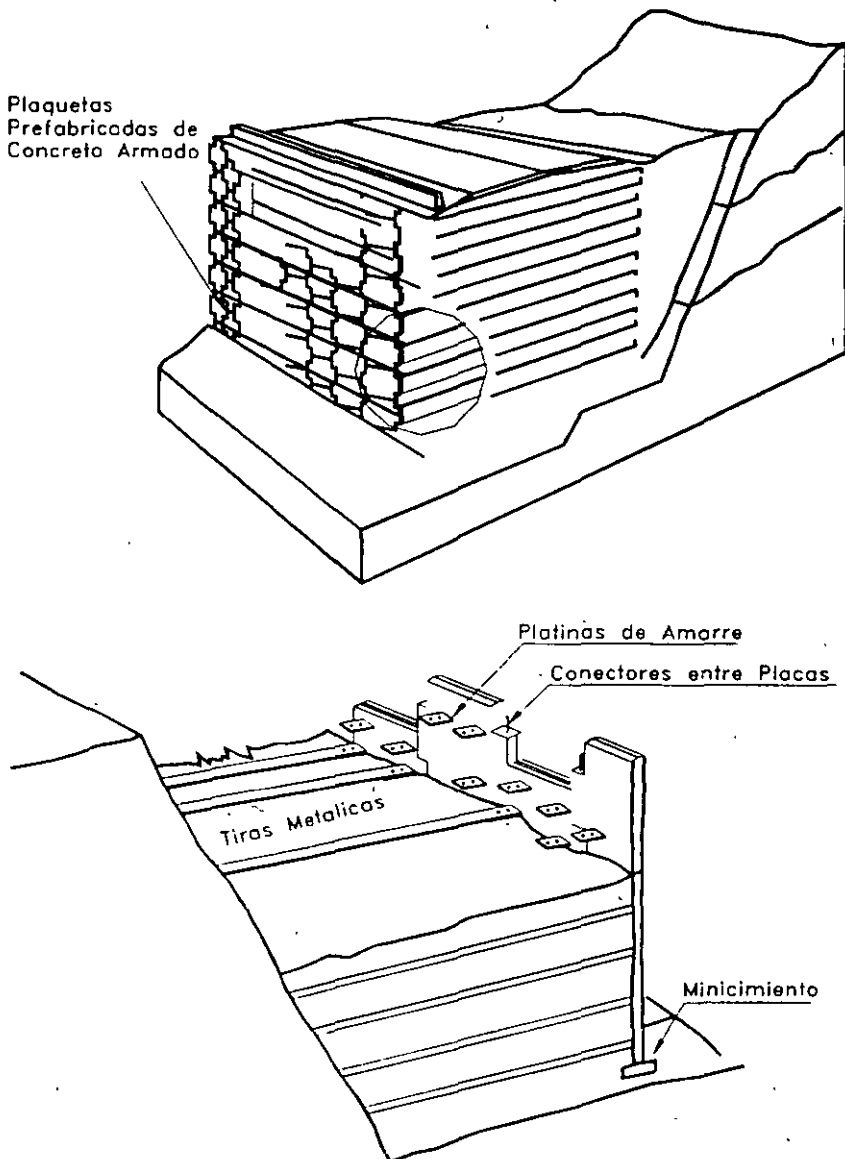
Muro de tierra armada con refuerzo de tiras metálicas.
